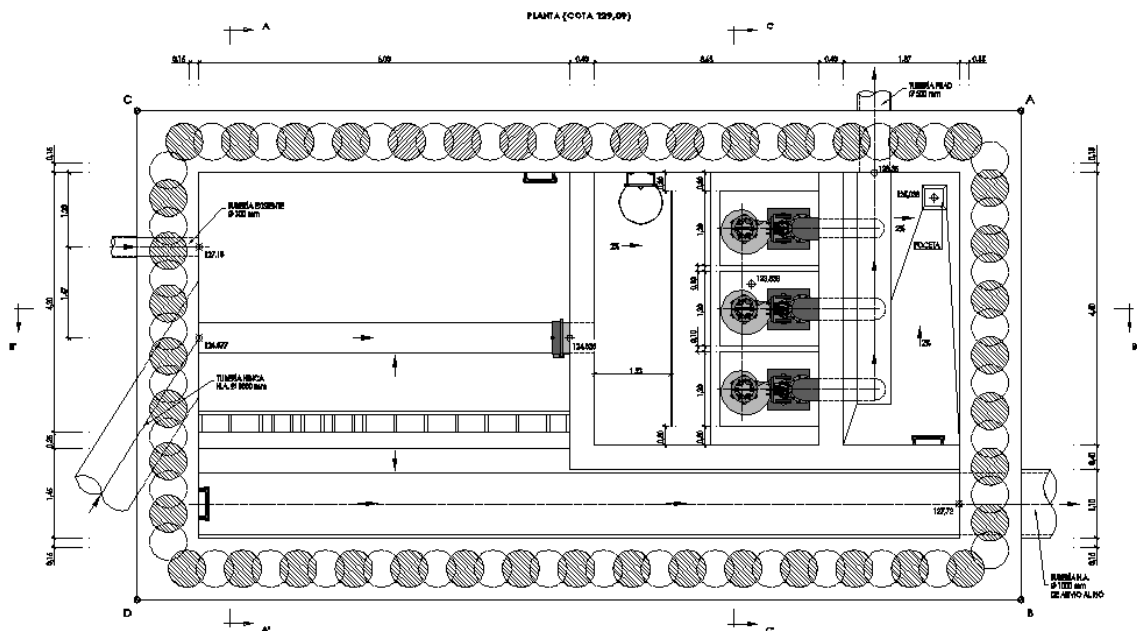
Planta de pantalla de pilotes aliviadero-bombeo Argame
